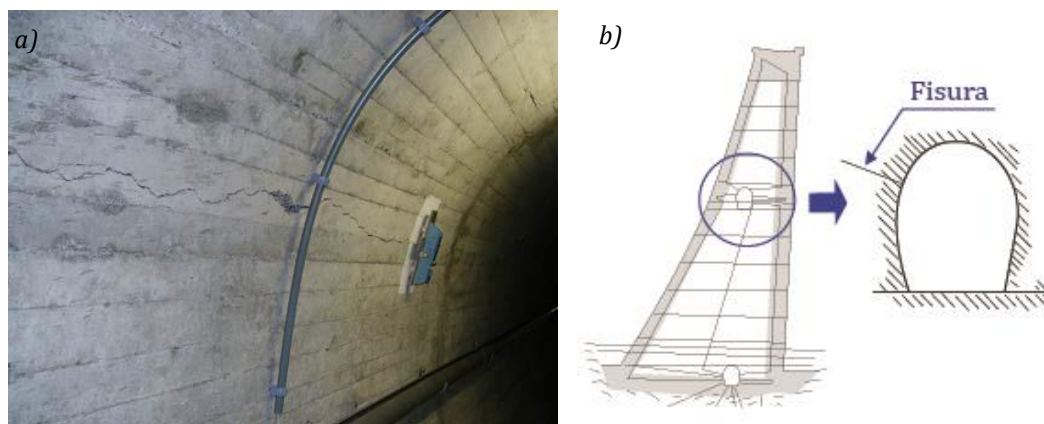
a) Fisura en hastial aguas abajo en la presa de Isola y b) Esquema de la fisuración en la galería (Araújo, 2008).
